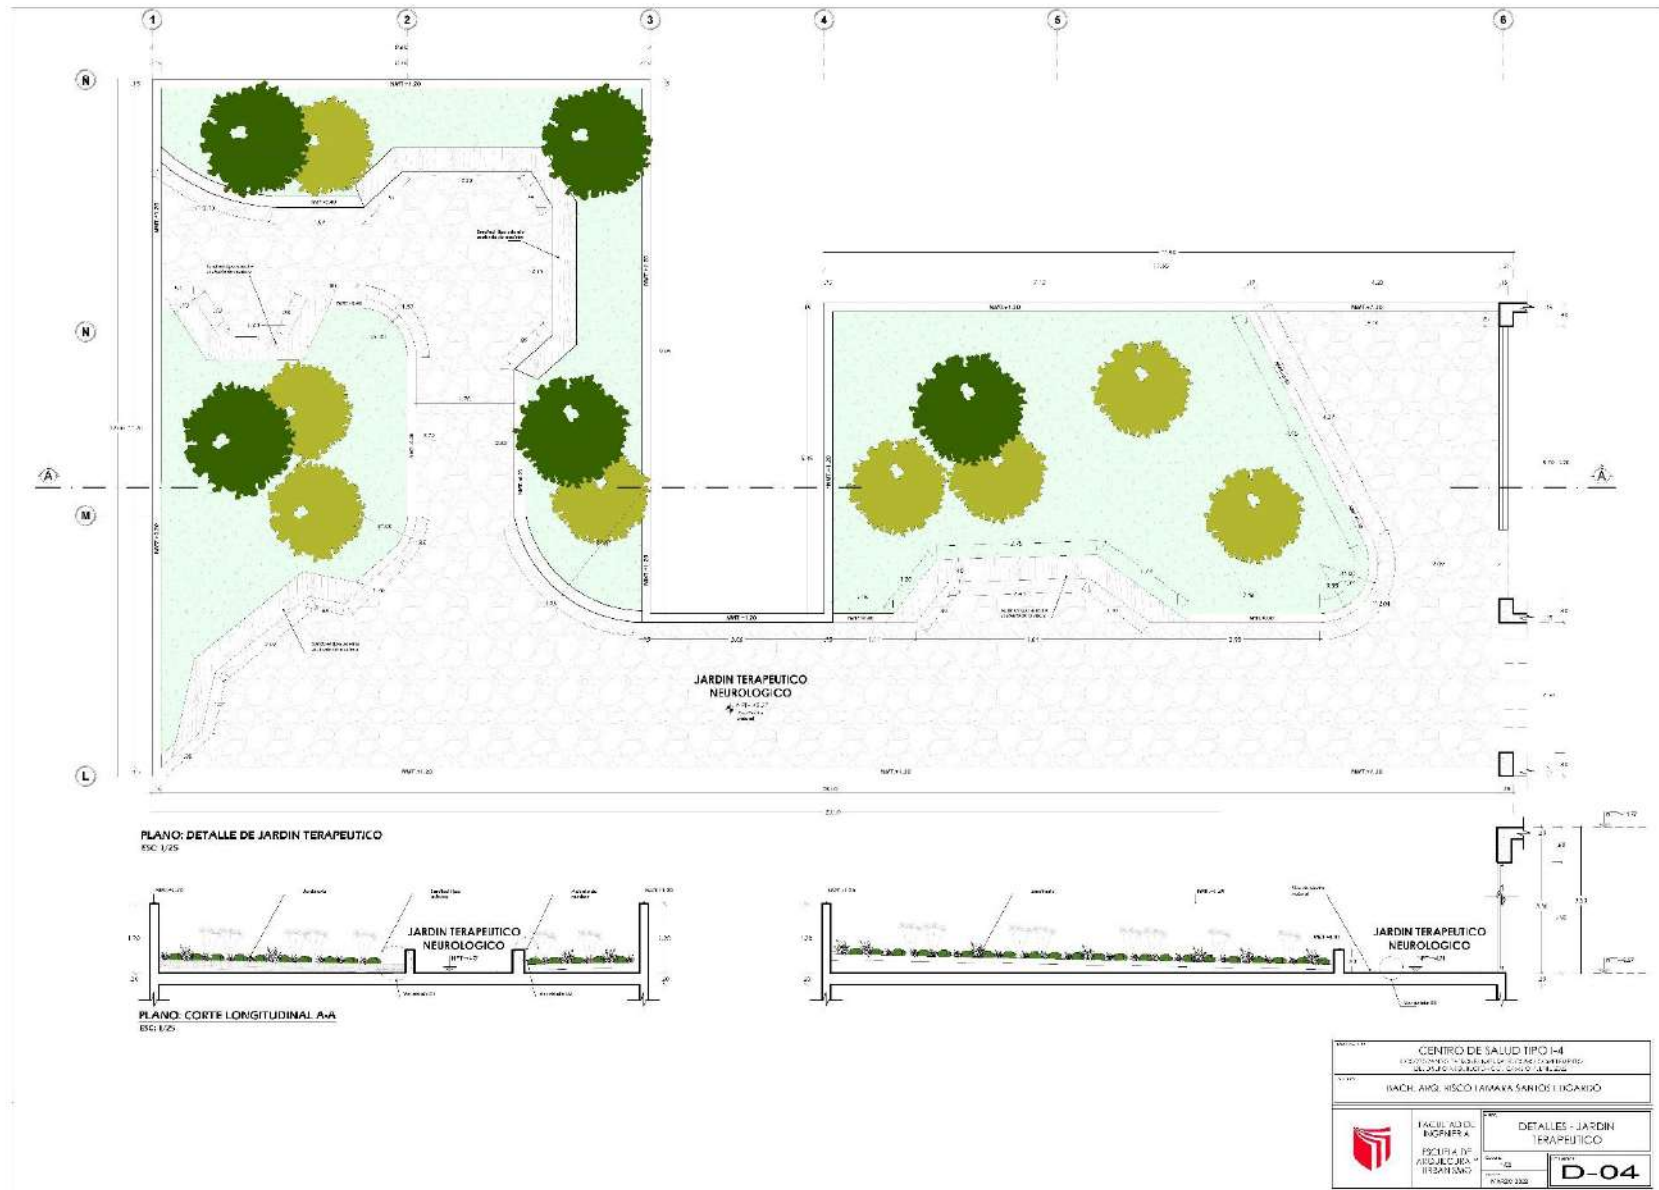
Detalle Arquitectónico Jardín terapéutico.
